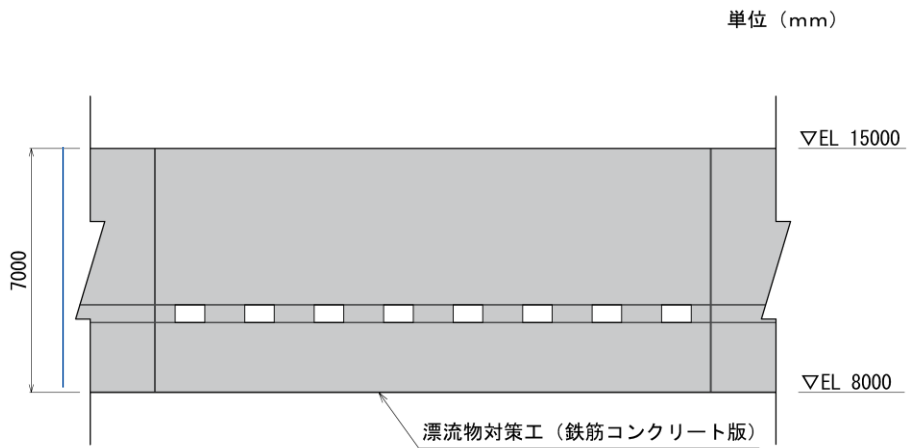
(2) 漂流物対策工 (鉄筋コンクリート版) の構造概要図 (正面図)
